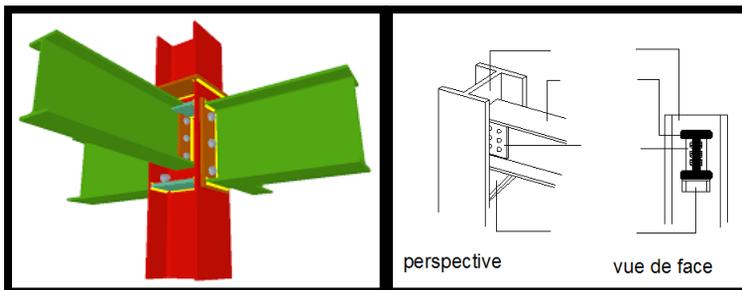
schéma de jonction poteau-poutre/ Source : les auteurs
